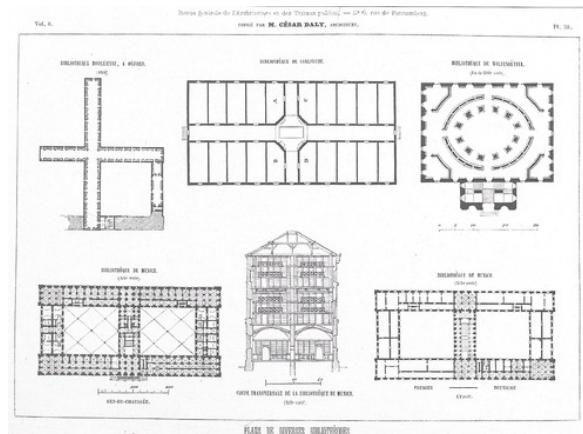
Tableau mit Grundrissen von Bibliotheksgebäuden in der *Revue générale d'architecture et des travaux publics*, tome 8, 1849-50.
